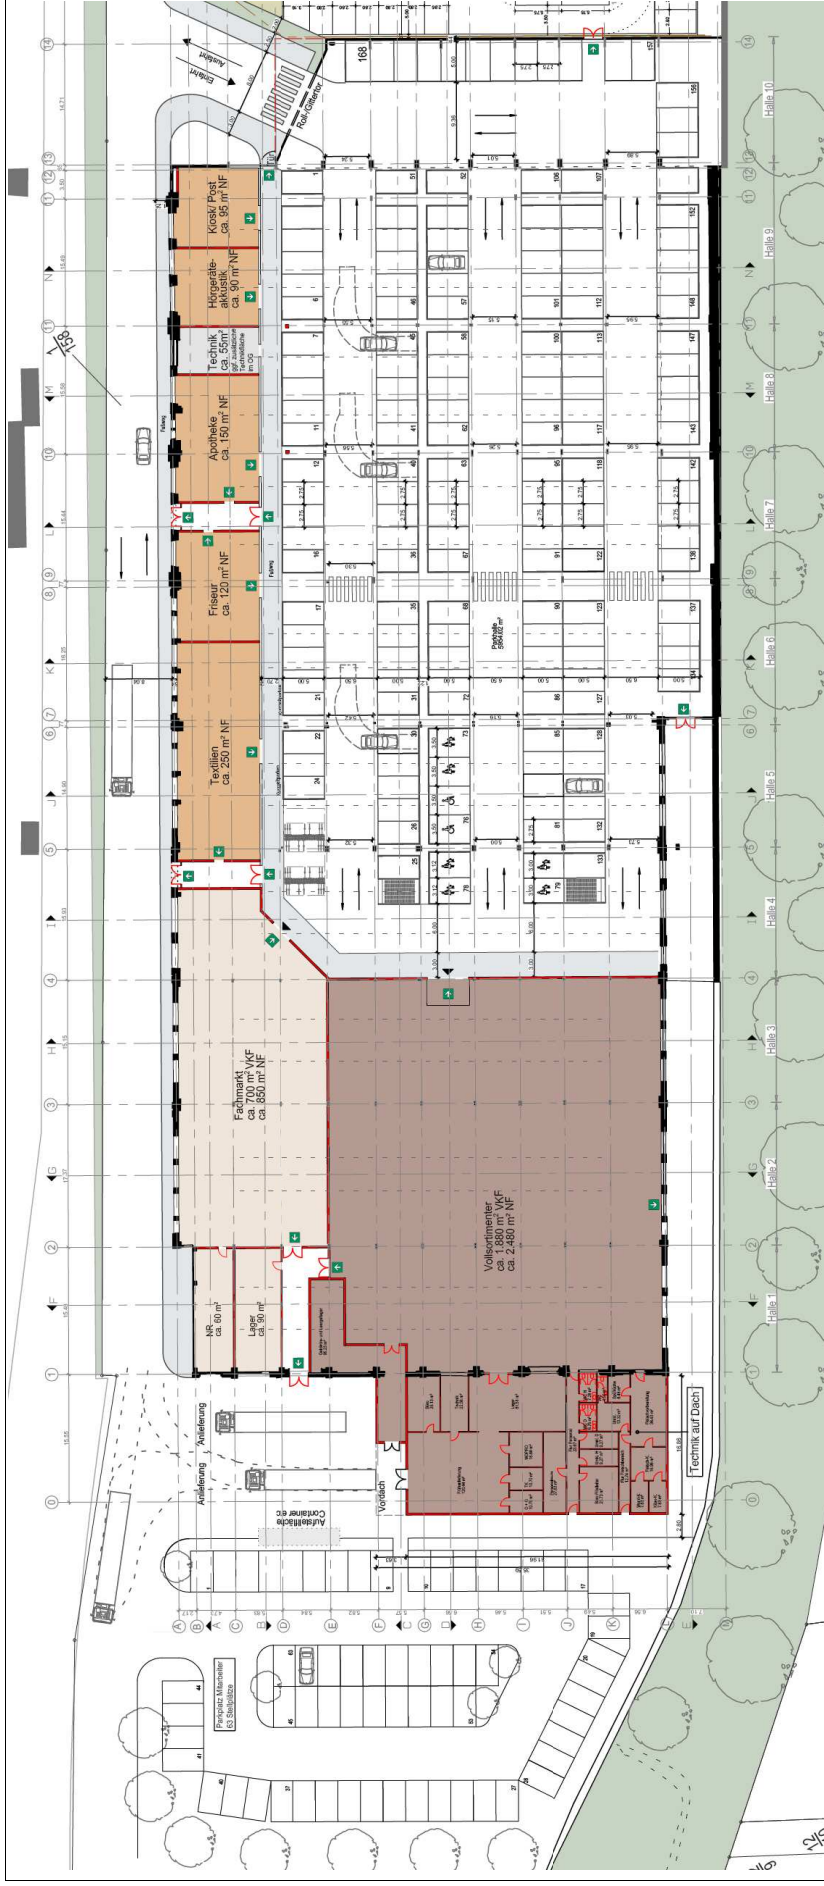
Übersicht Parken, Märkte und Parkhalle (nicht eingenordet).
